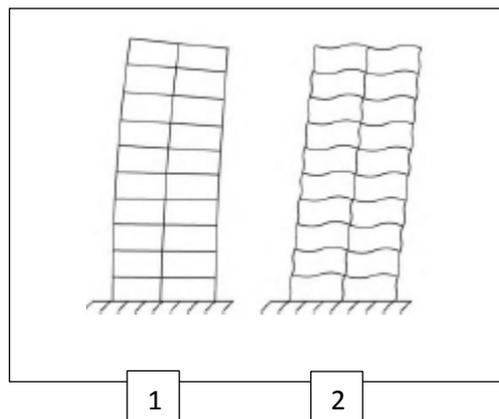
Le mouvement latéral dans la trame rigide: (1) Déformation causée par l'encastrement, (2) Déformation causée par la flexion des poteaux et poutres
